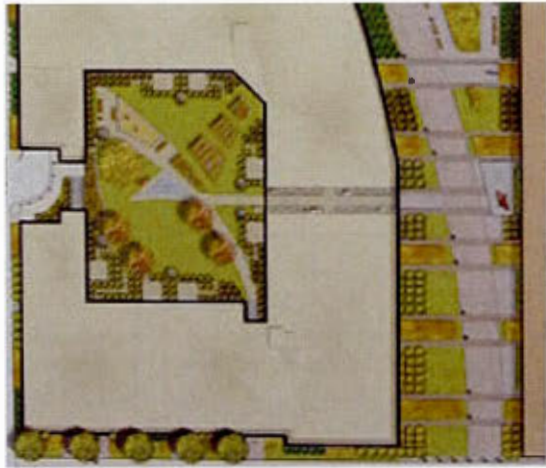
(suite) : Propositions reçues pour le volet privé de la transformation des terrains de Lavo
